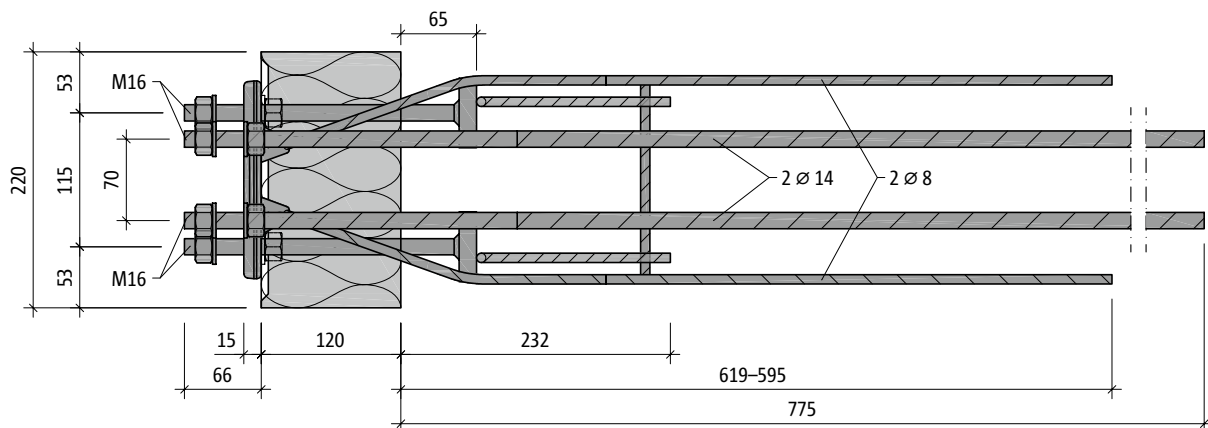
Schöck Isokorb® XT Typ SK-M1-V1: Grundriss
